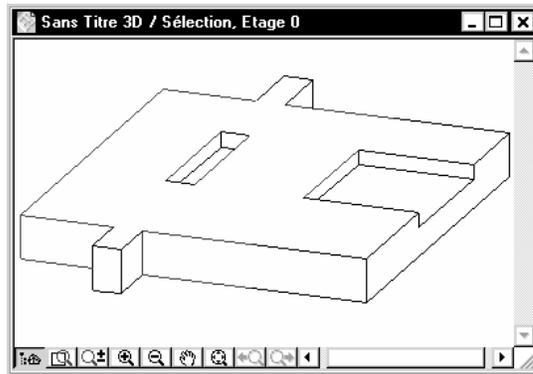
Les matières de la dalle et des poutres sont identiques
